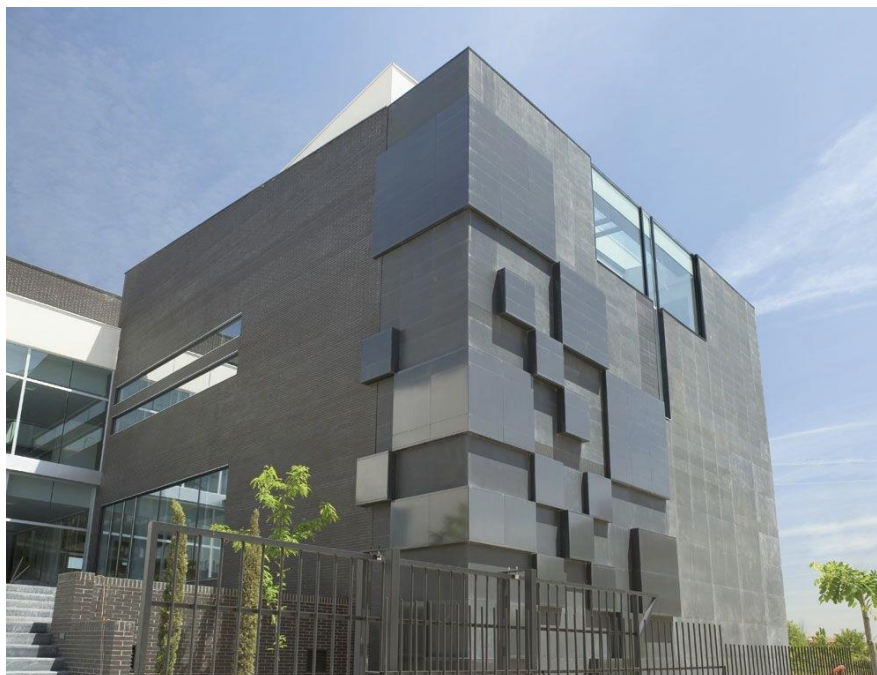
Fachada ventilada revestida com painéis de betão polímero [6]
